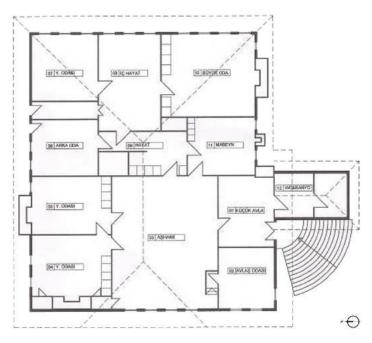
The ground floor plan of Hurşit Bey Konağı (Afife Batur)
